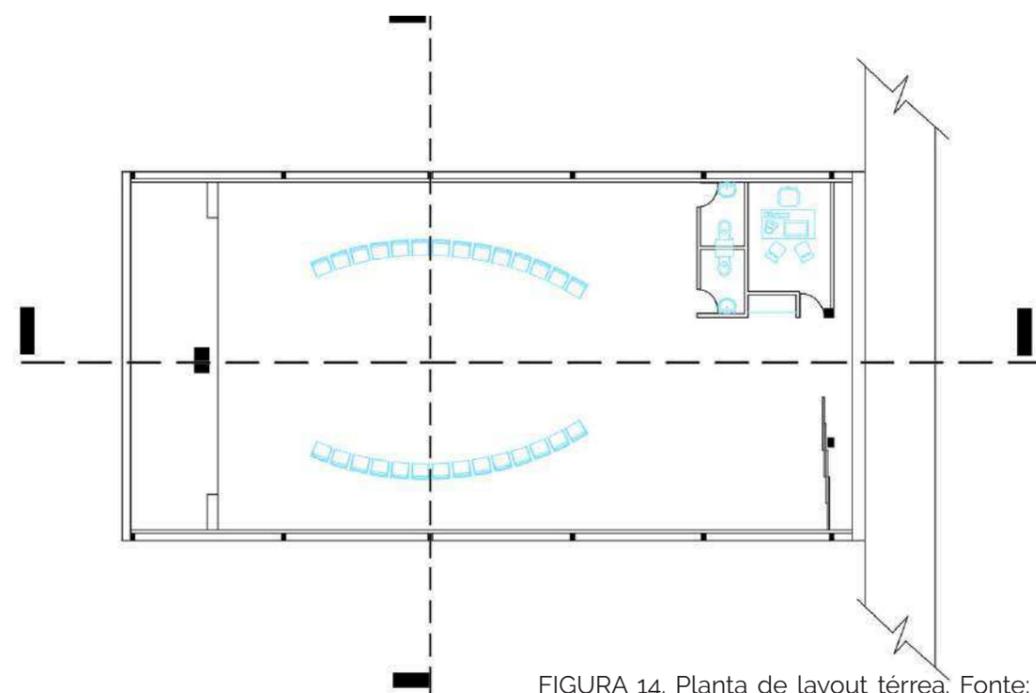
Planta de layout térrea. Fonte: Natura Futura, n.d.
